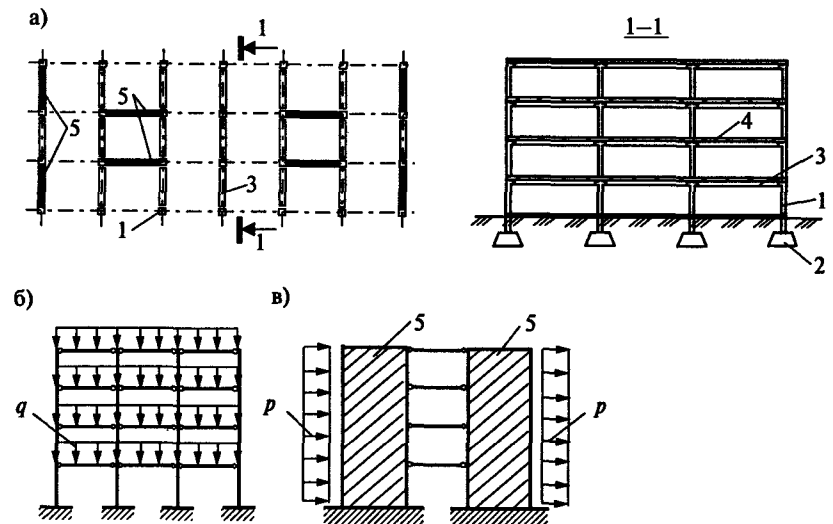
Связевой каркас здания: а) план здания, разрез; б) расчетная схема при расчете на вертикальную нагрузку; в) расчетная схема при расчете на горизонтальную нагрузку; 1 — колонна; 2 — фундамент; 3 — разрезной (однопролетный) ригель; 4 — плиты перекрытия; 5 — диафрагмы жесткости
